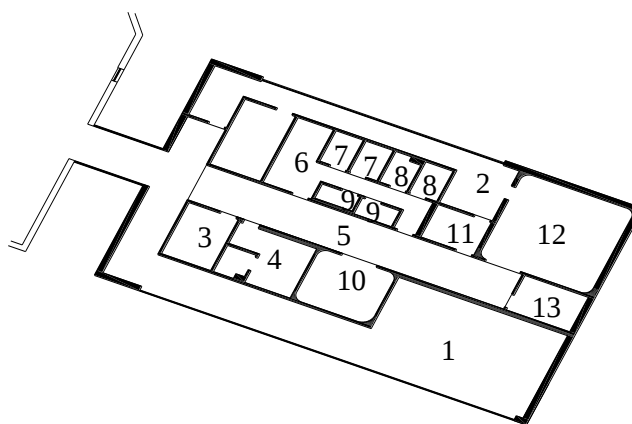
| Planta esquemática do Piso - 1 - Bloco Operatório.
